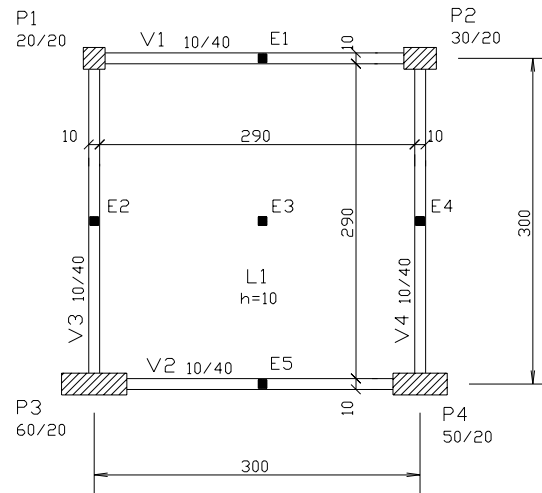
Forma dos pavimentos e posição dos pontaletes (em cm)
